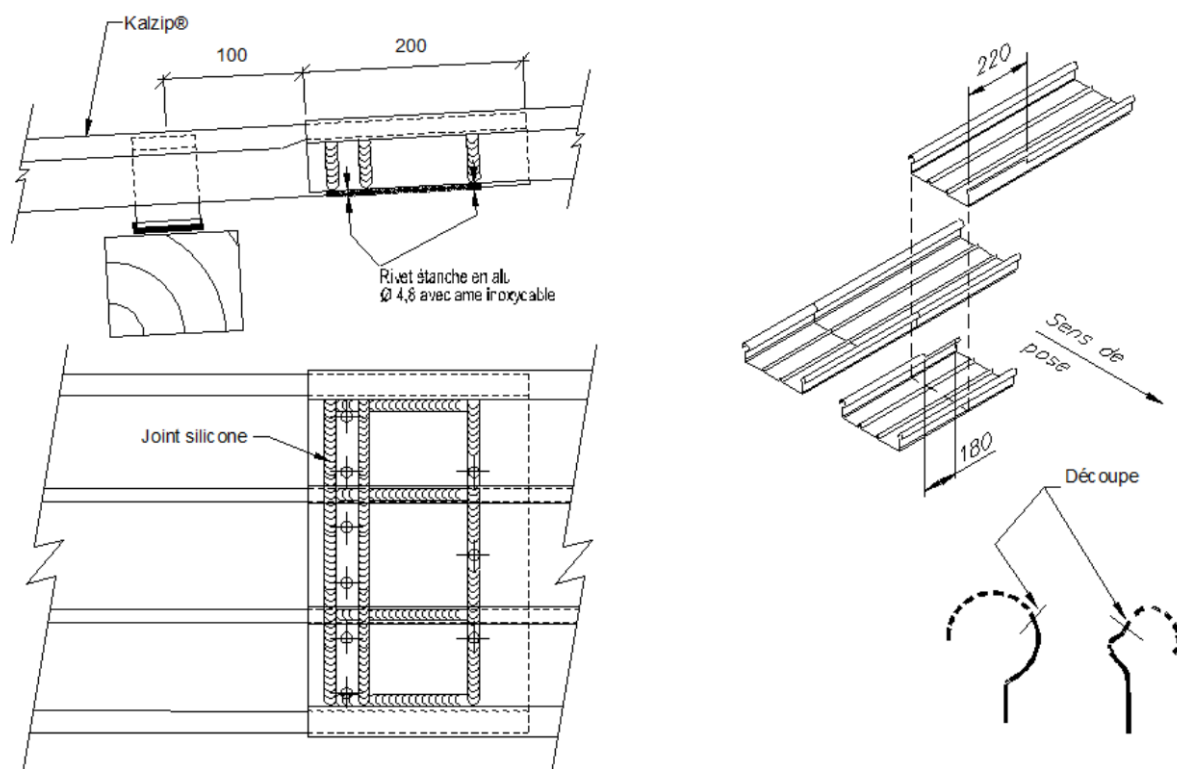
Détail recouvrement transversal triple barrière (pente $\geq 7\%$)
